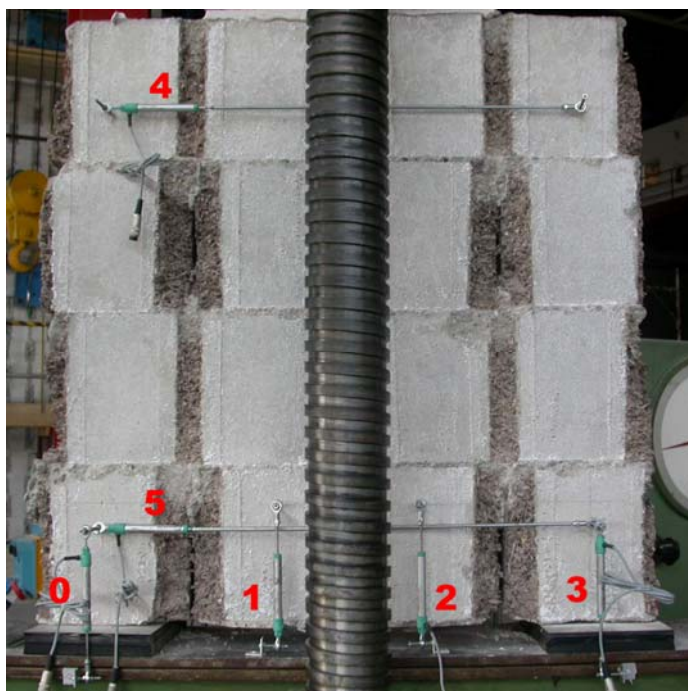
Esempio concreto di strumentazione applicata al pannello
